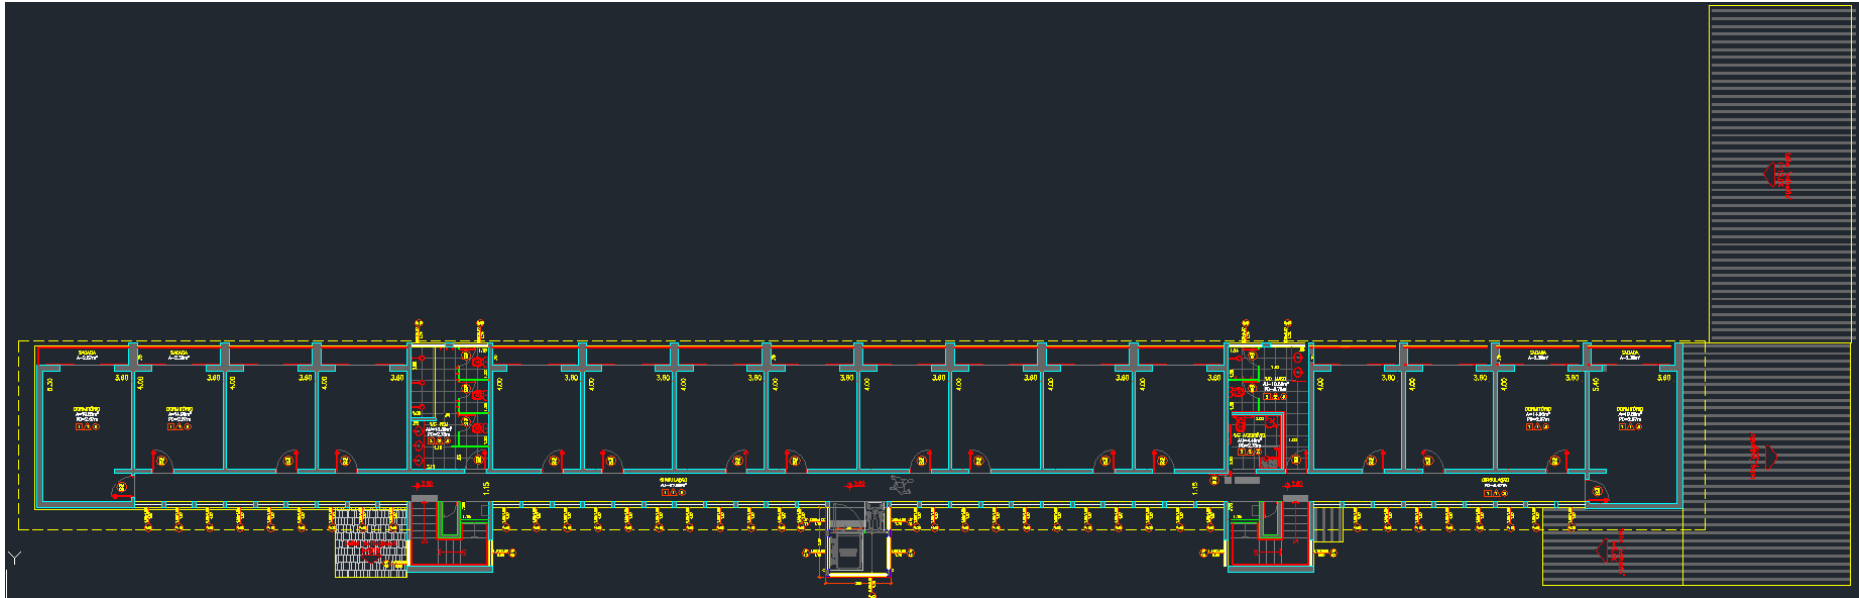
Planta do pavimento superior da Moradia Estudantil Bloco A.
